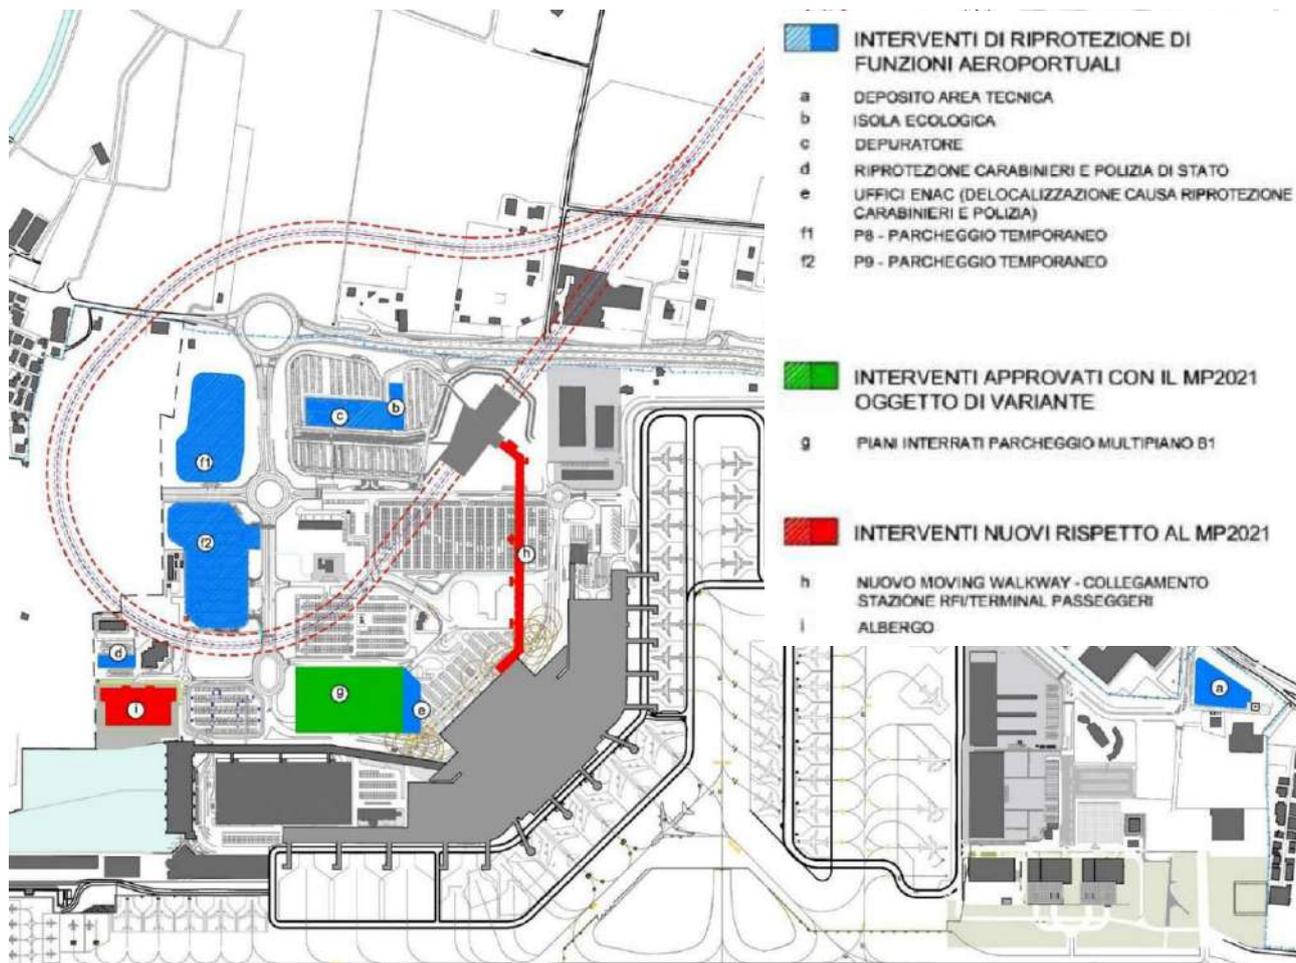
Interventi previsti nella variante 2018 del Masterplan
